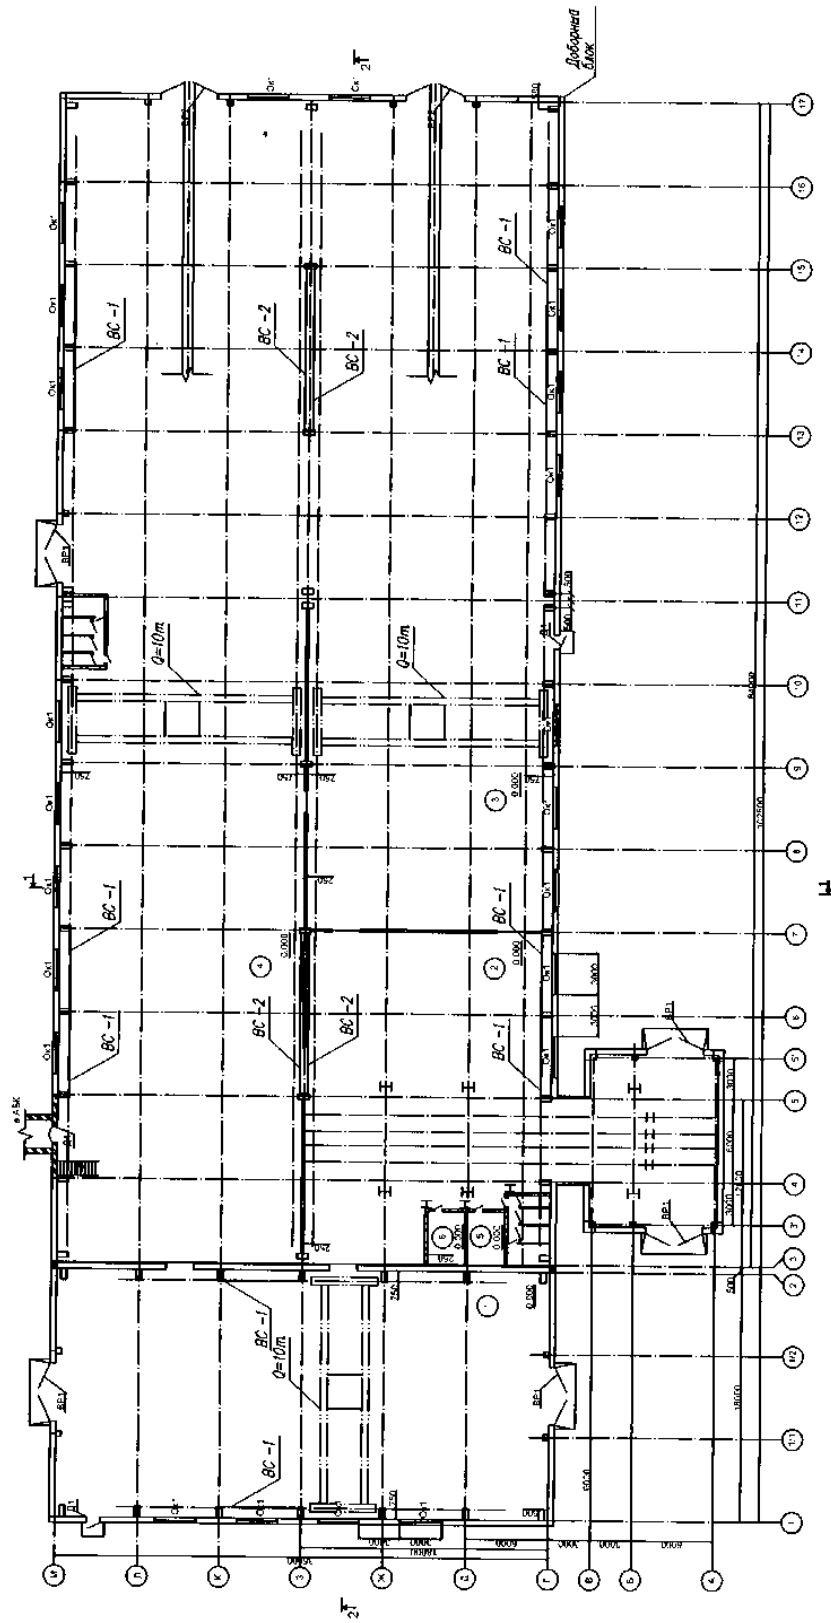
Схема выполнения плана основного цеха завода по производству железобетонных конструкций
